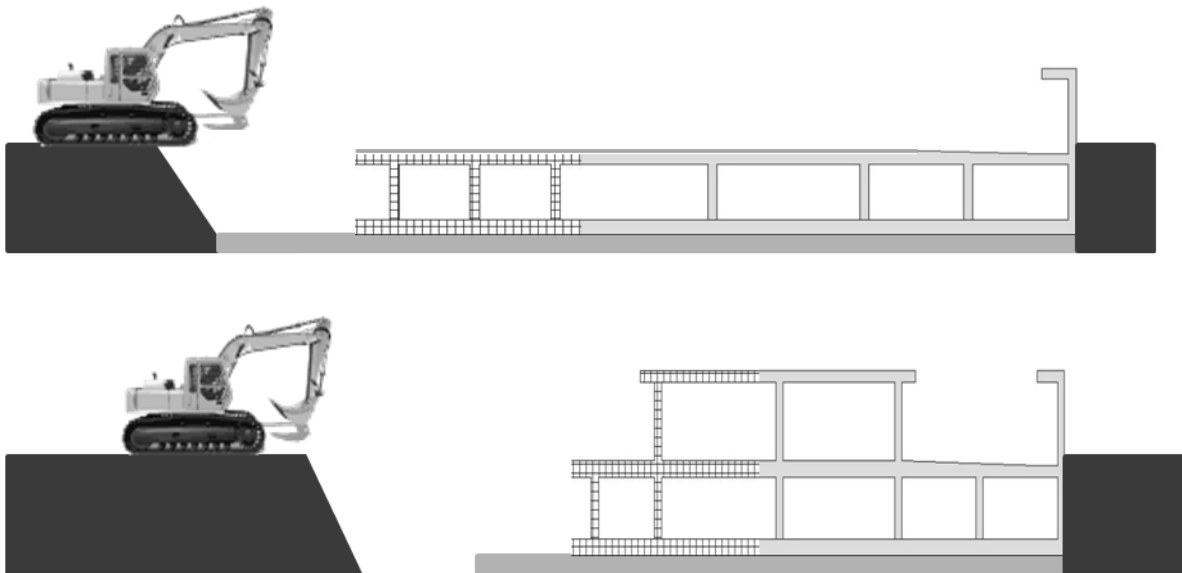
; Se visualiza la cimentación para tramo y por otra parte la de la estación con andén.
